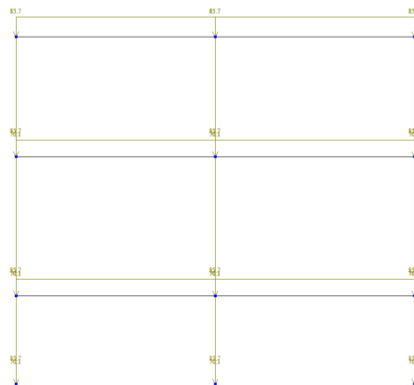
Нагрузки от покрытий и перекрытий
